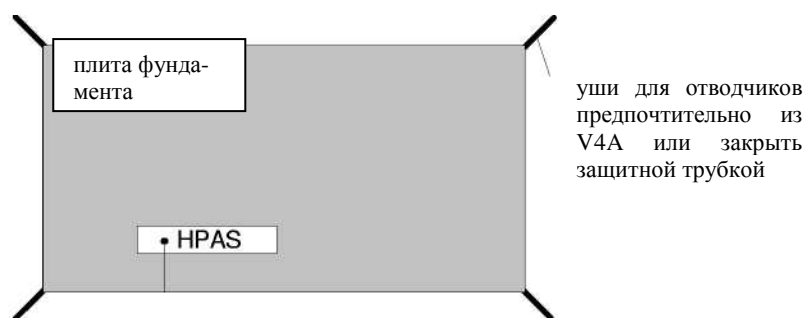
Вид сверху на фундаментную плиту с ушами для отводчиков и ГШВП.
